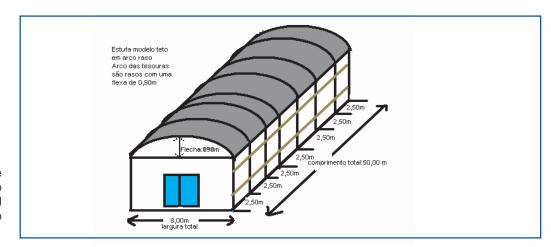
Croquis de estufa 'teto em arco' raso de construção artesanal com canos de ferro galvanizado.
